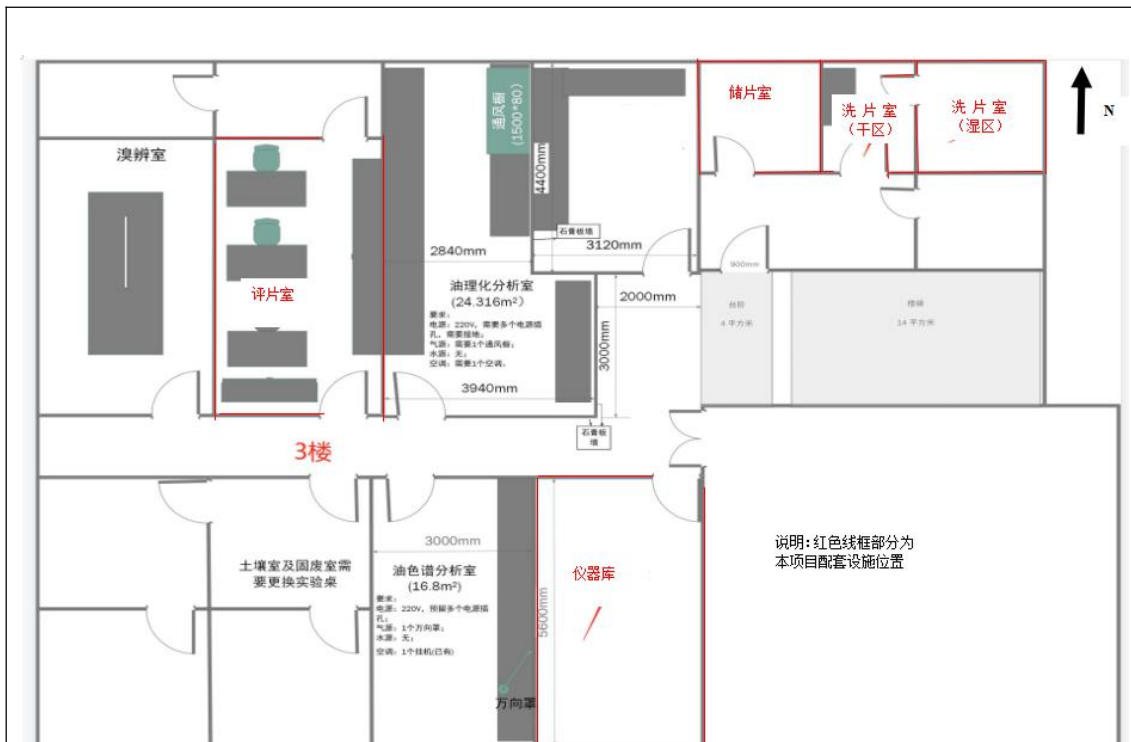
安徽新力电业高技术有限责任公司厂房3楼平面布置示意图
